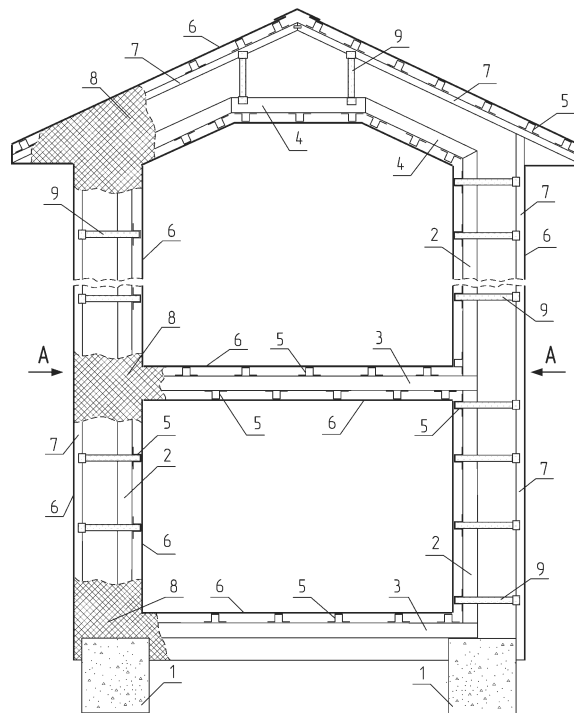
Поперечный разрез здания: 1 – фундамент; 2 – колонна внутреннего каркаса; 3 – ригель внутреннего каркаса; 4 – балка перекрытия; 5 – гнутый профиль; 6 – лист опалубки; 7 – внешний каркас; 8 – лёгкий бетон; 9 – временный фиксатор
